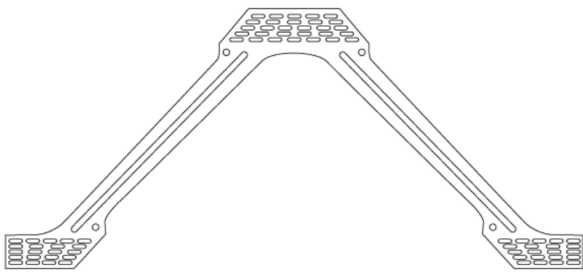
Posi-Strut® Metal Web Joists – élément d'âme en acier galvanisé
